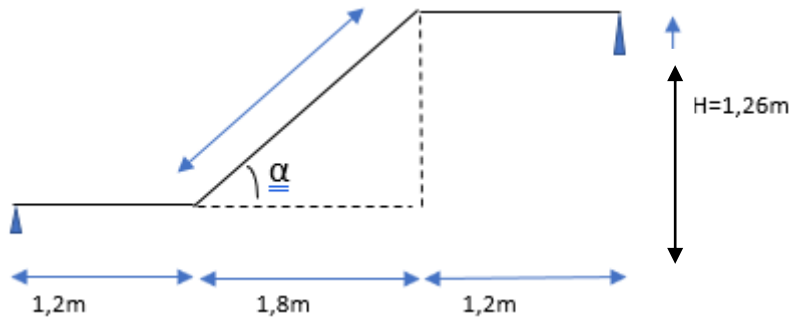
Schéma du la 2<sup>eme</sup> paillasse
